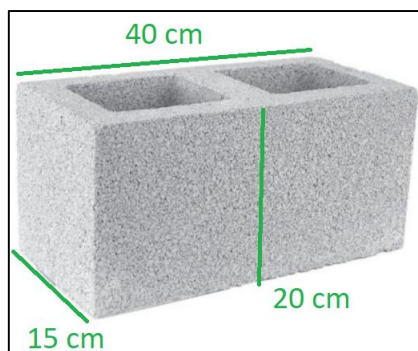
Dimensiones de elemento de mampostería utilizado en la vivienda tipo social.
